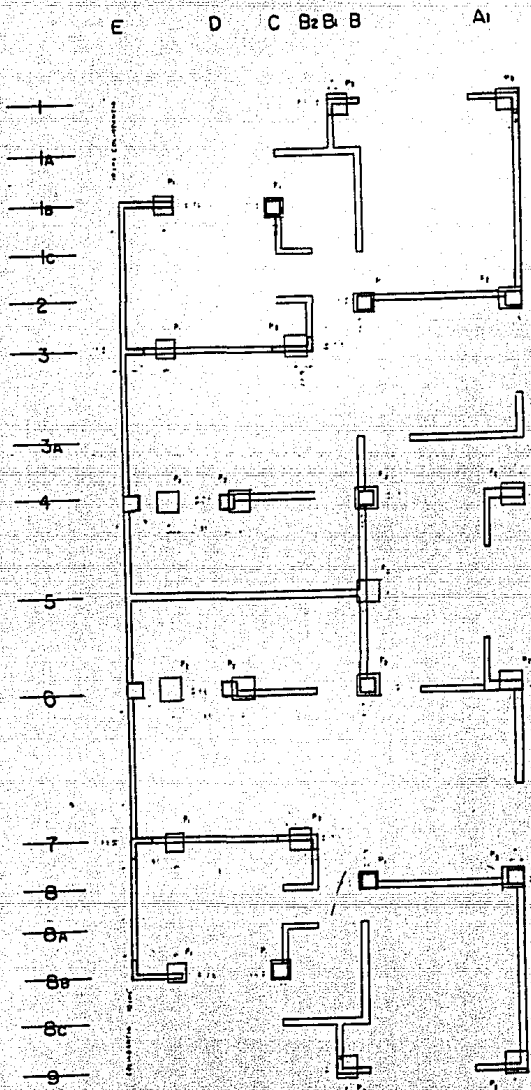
Planta del edificio y ubicación de los pilotes
